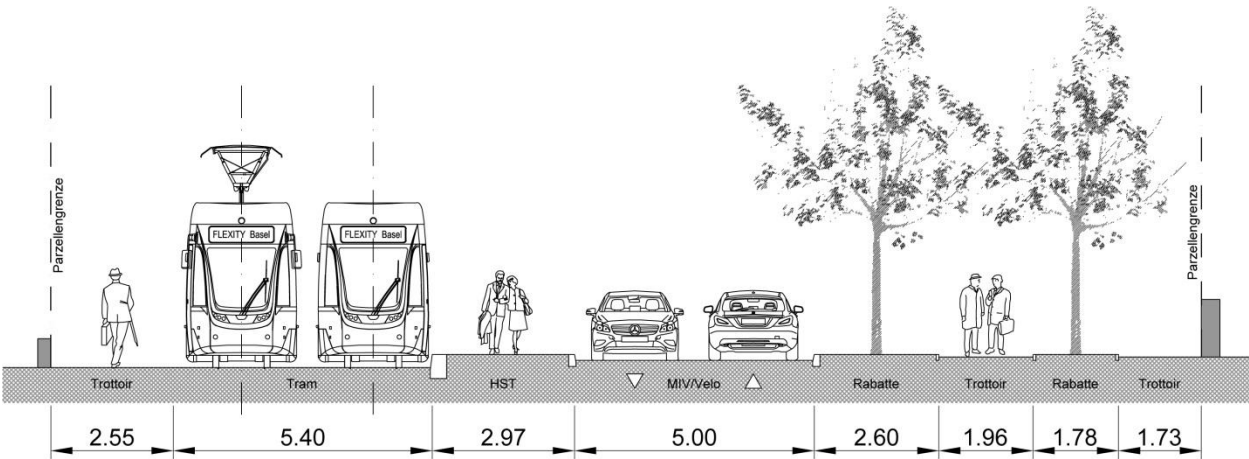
Strassenquerschnitt der Bruderholzallee mit der Haltestelle Hauensteinstrasse
